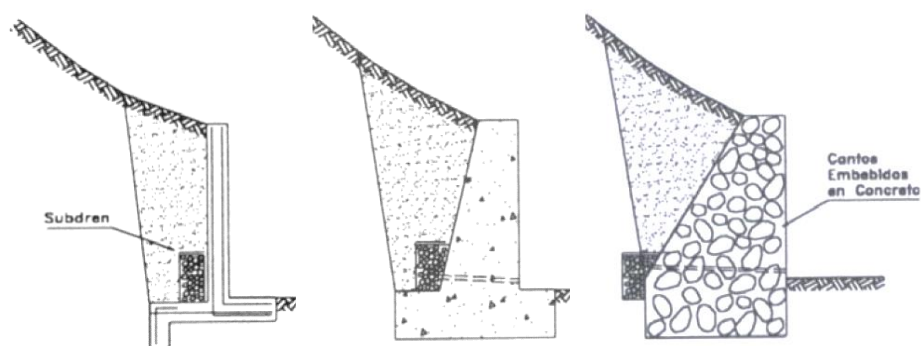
Tipos de estructuras de retención rígidas. Fuente: ACG (2009)
